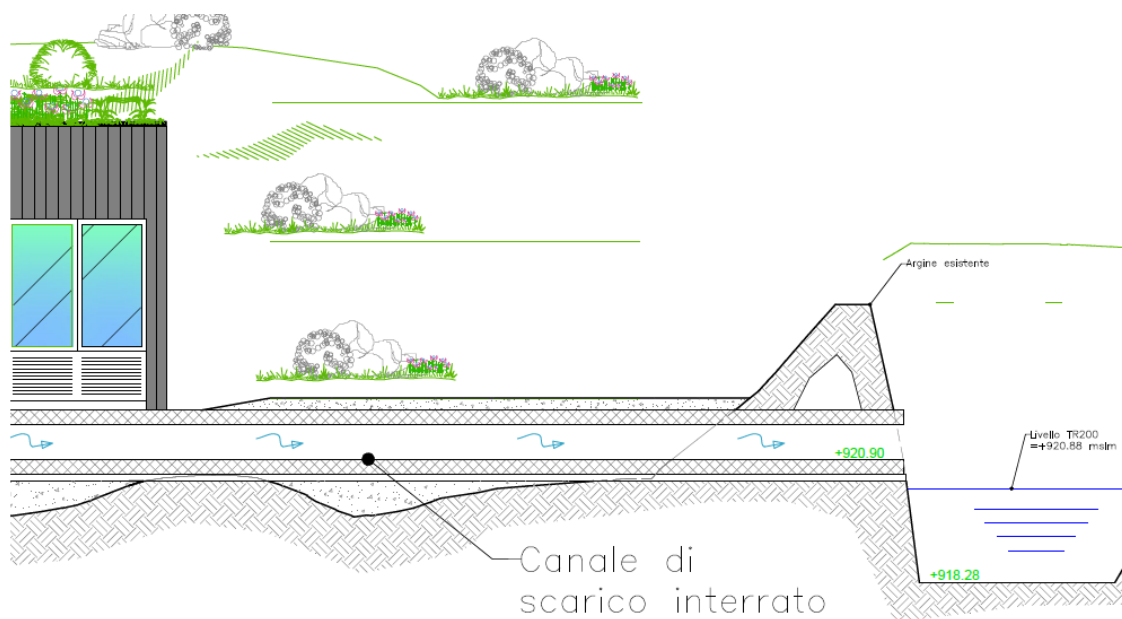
Estratto sezione di progetto del canale di scarico della centrale.
